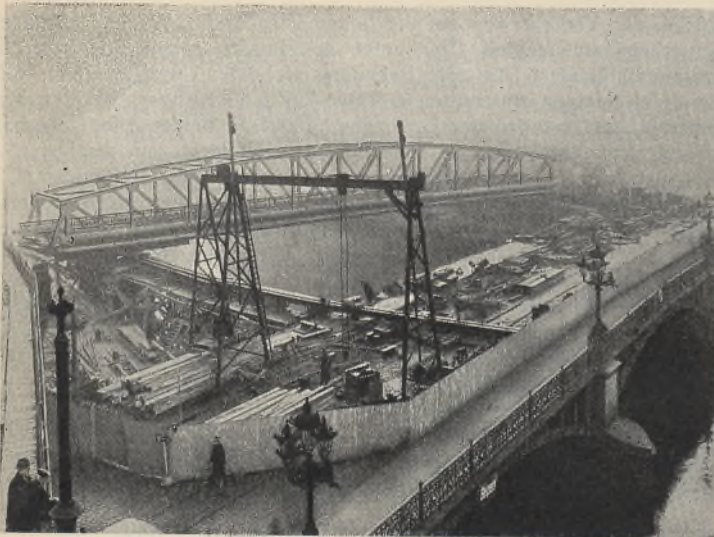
Umbau der Jannowitzbrücke in Berlin. Bauaufnahme.
